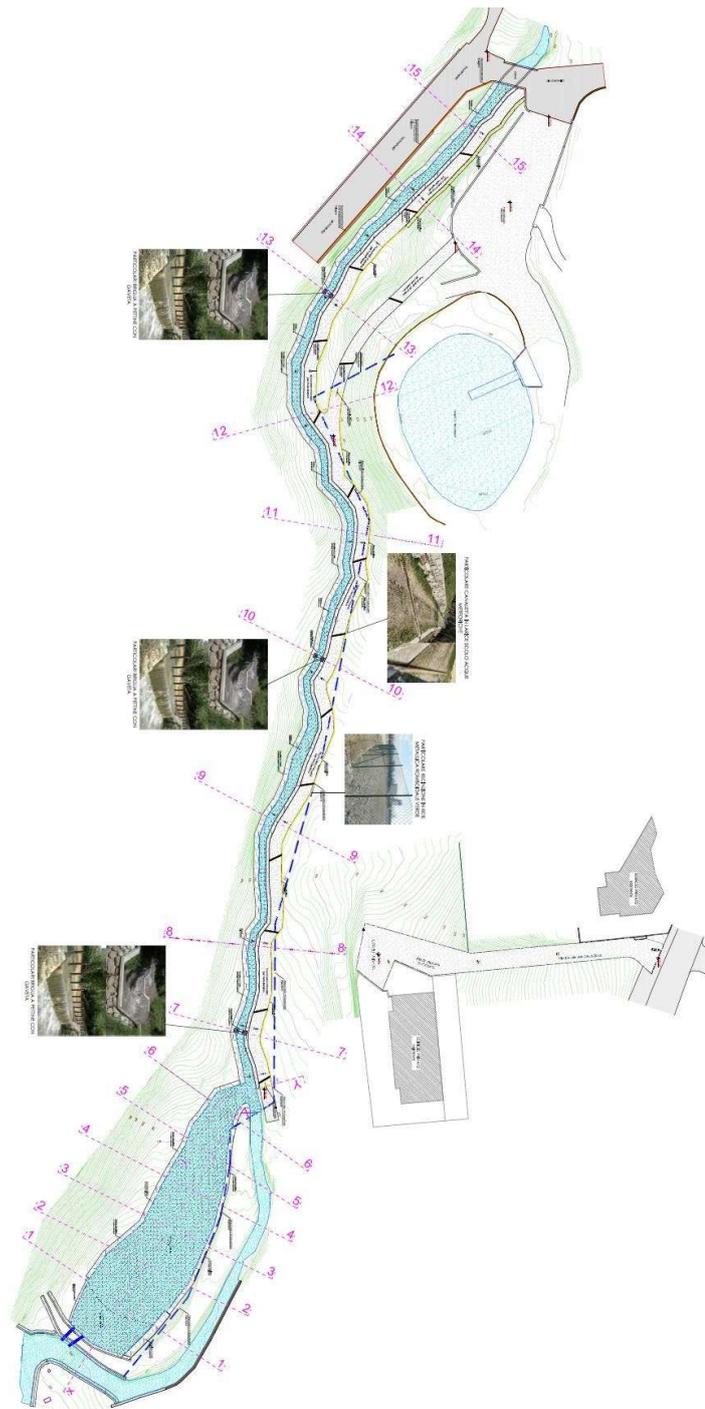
Gandosso: planimetria progetto (da Studio Fattibilità, Tav. 3)
